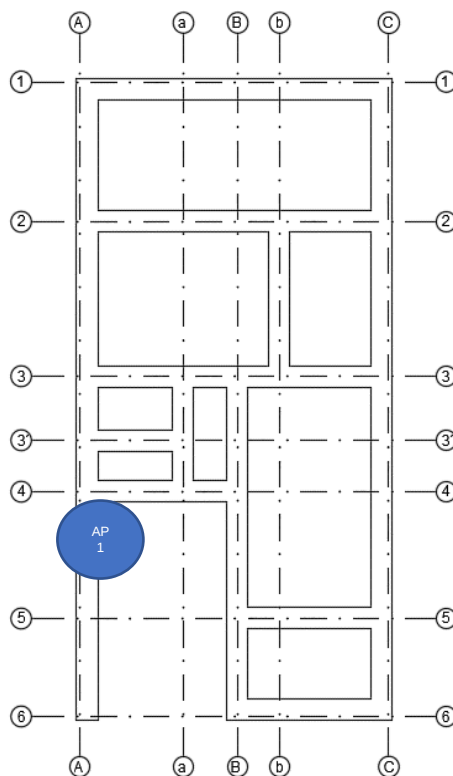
Planta de cimentación indicando sitio de exploración apique 1 de la fotografía 9. Fuente propia 2017.
